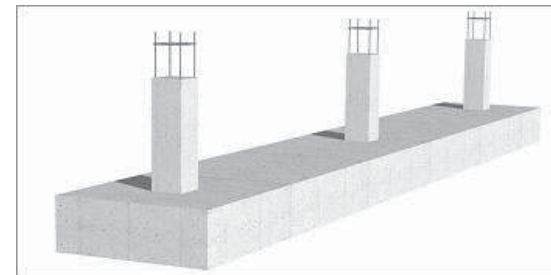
Zapata corrida, FUENTE: <http://www.um.edu.ar/um/fau>
